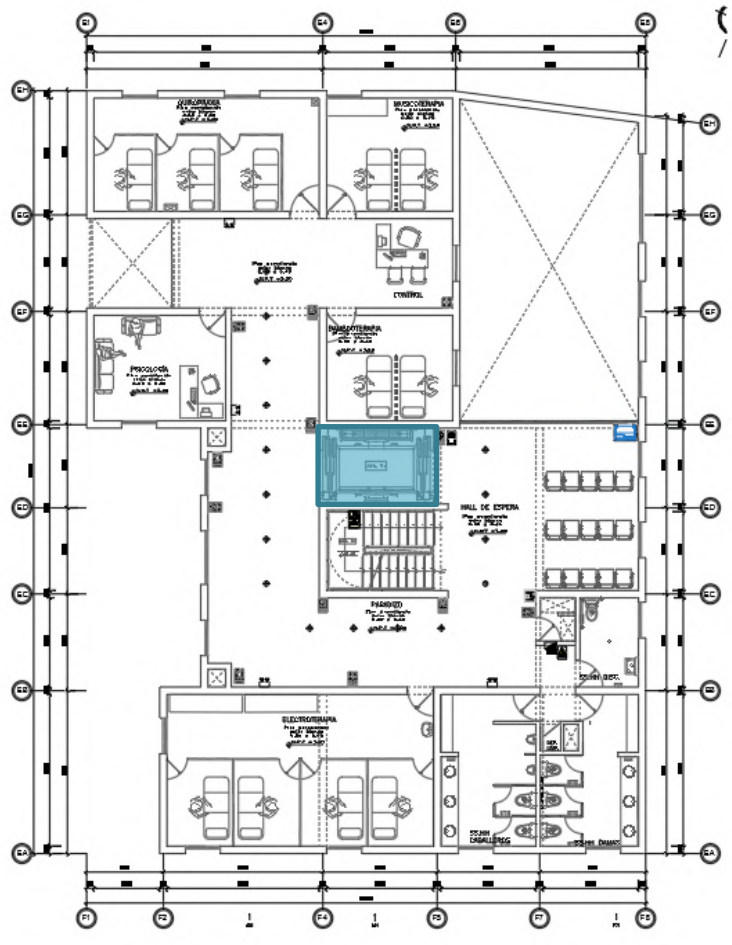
Planta de Segundo Nivel, ubicación de caja de ascensor.
